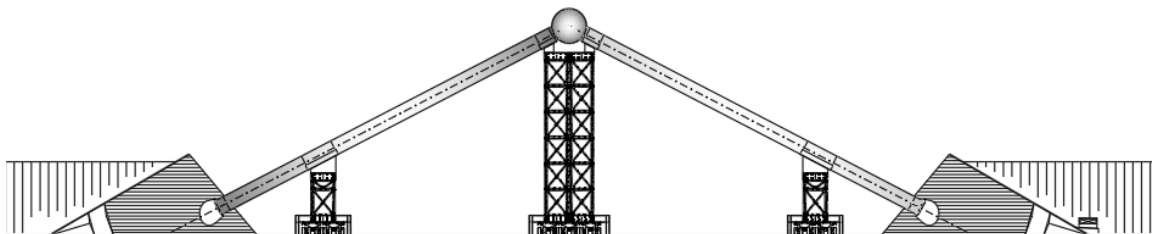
Fissaggio del cavalletto lato ovest alle spalle
